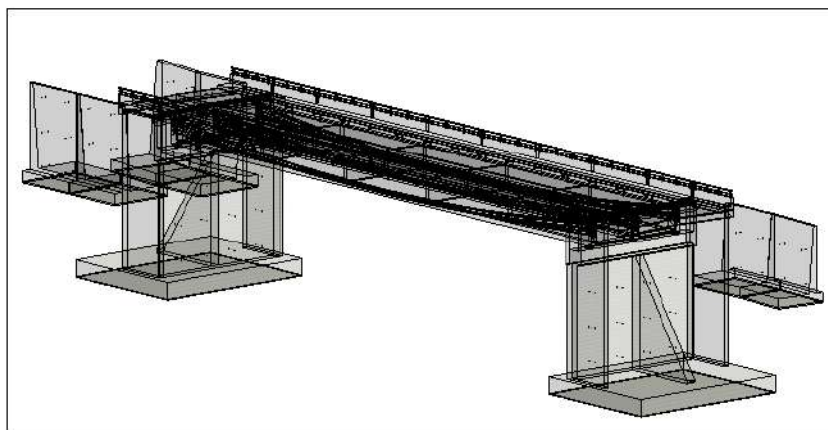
Vista de la sección típica del cajón de la losa del puente Huanchuy.
